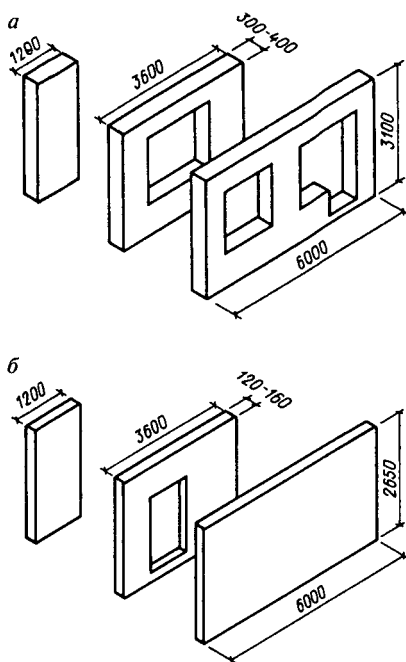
Виды железобетонных панелей для наружных (а) и внутренних (б) стен жилых зданий
